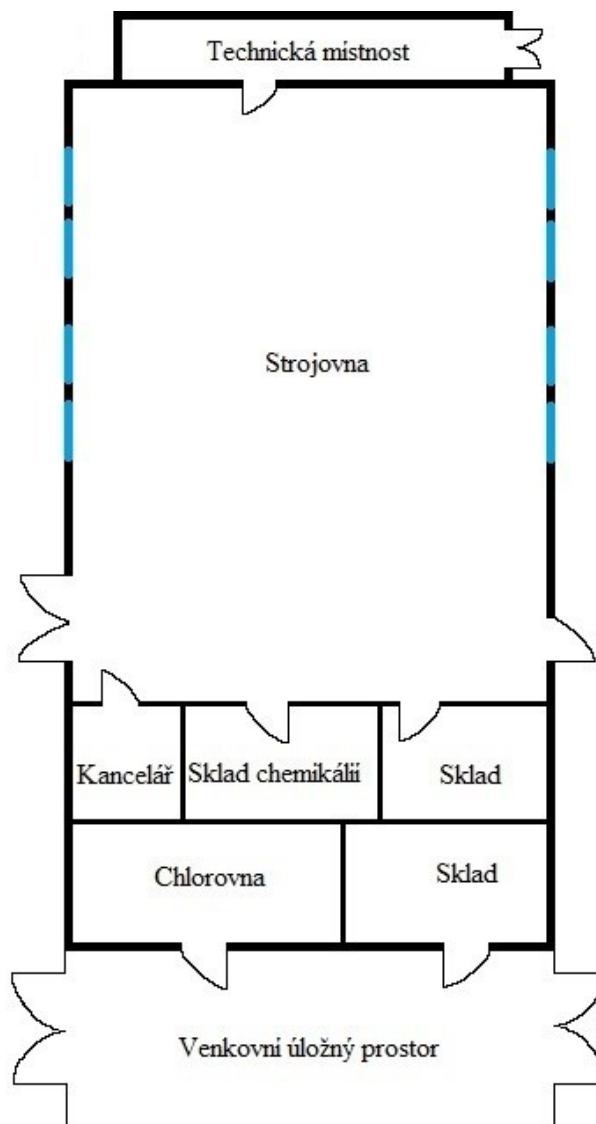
Půdorys budovy číslo 1 (vlastní)
